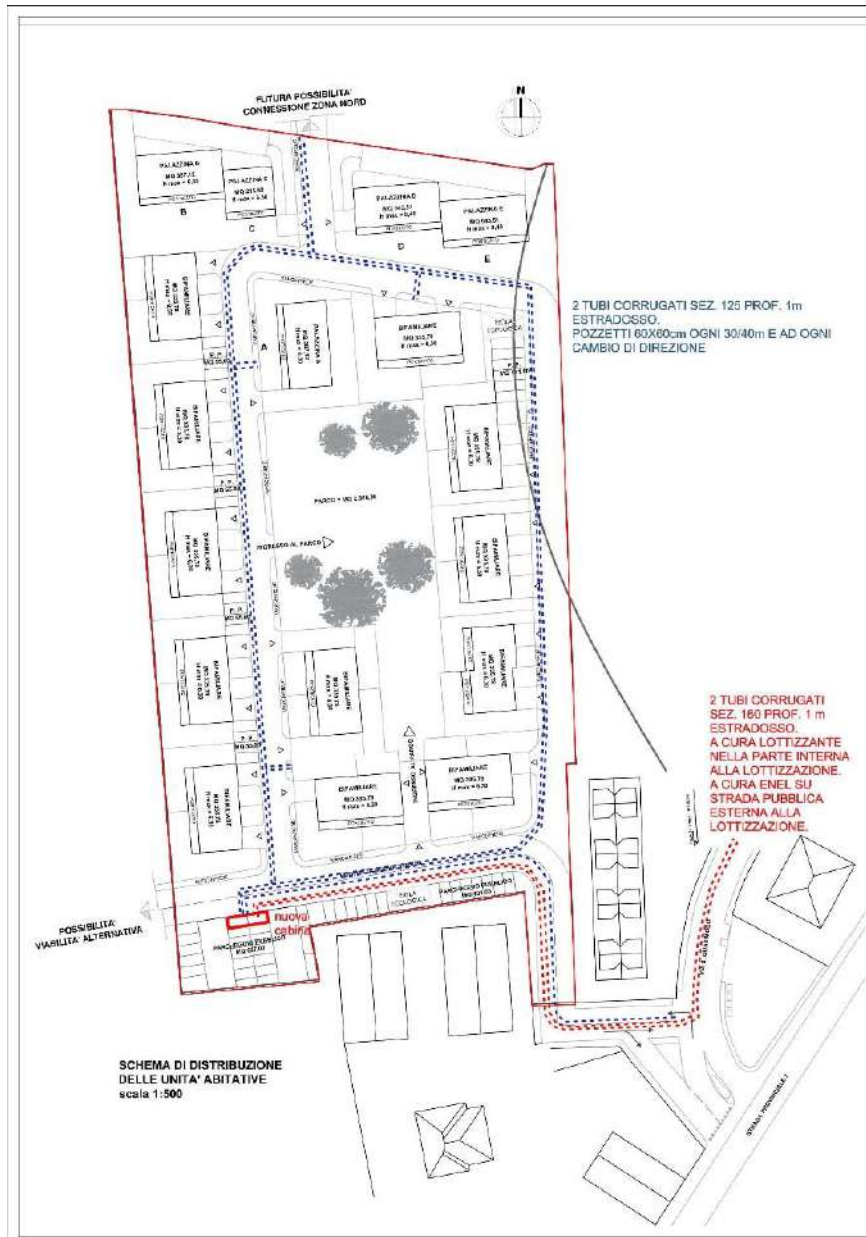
Planimetria di progetto reti elettriche (Progettazione, Dott. Arch. Paolo Pagani)
